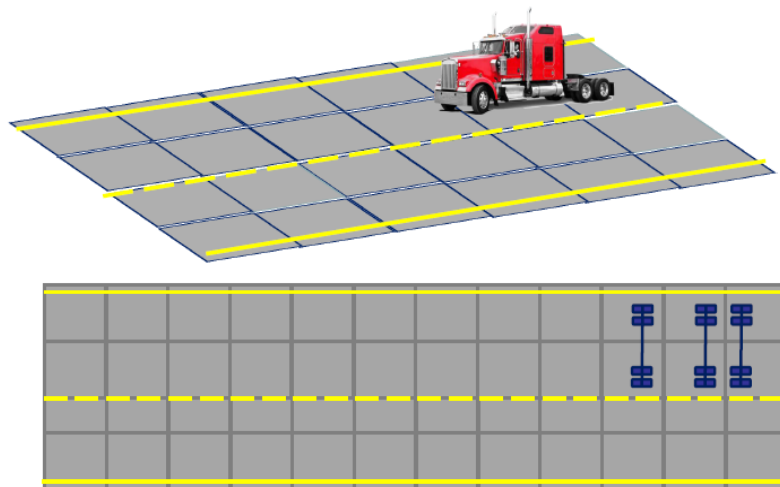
Dimensiones de pavimentos tradicionales
